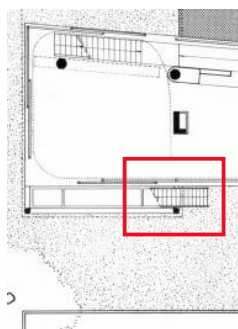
e 98: Articulação do segundo e terceiro pavimentos.
